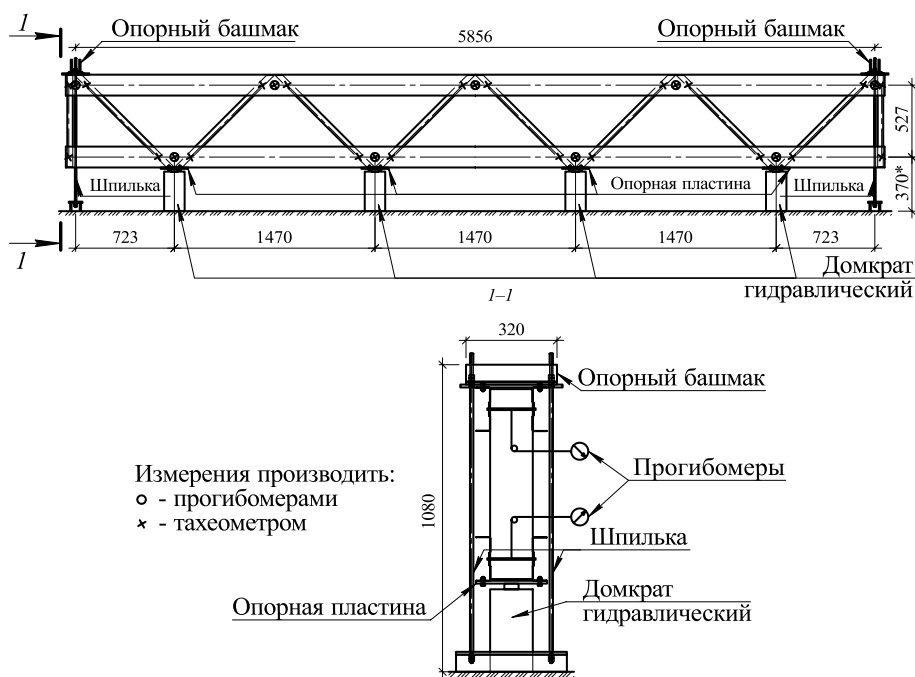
Схема испытательной установки для фермы пролетом 6 м
